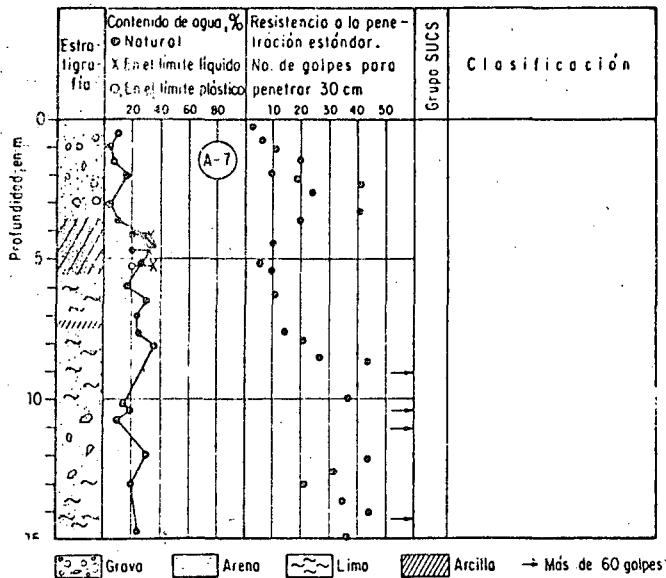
' Perfil estratigráfico. Estudio 32. Planta de PVC
